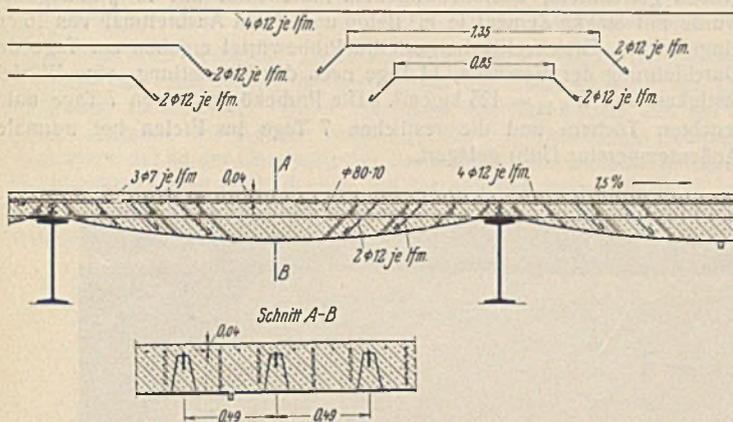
Zusätzliche Querbewehrung bei Fahrbahnplatten mit aussteiften Tonnenblechen über den Unterzügen.
